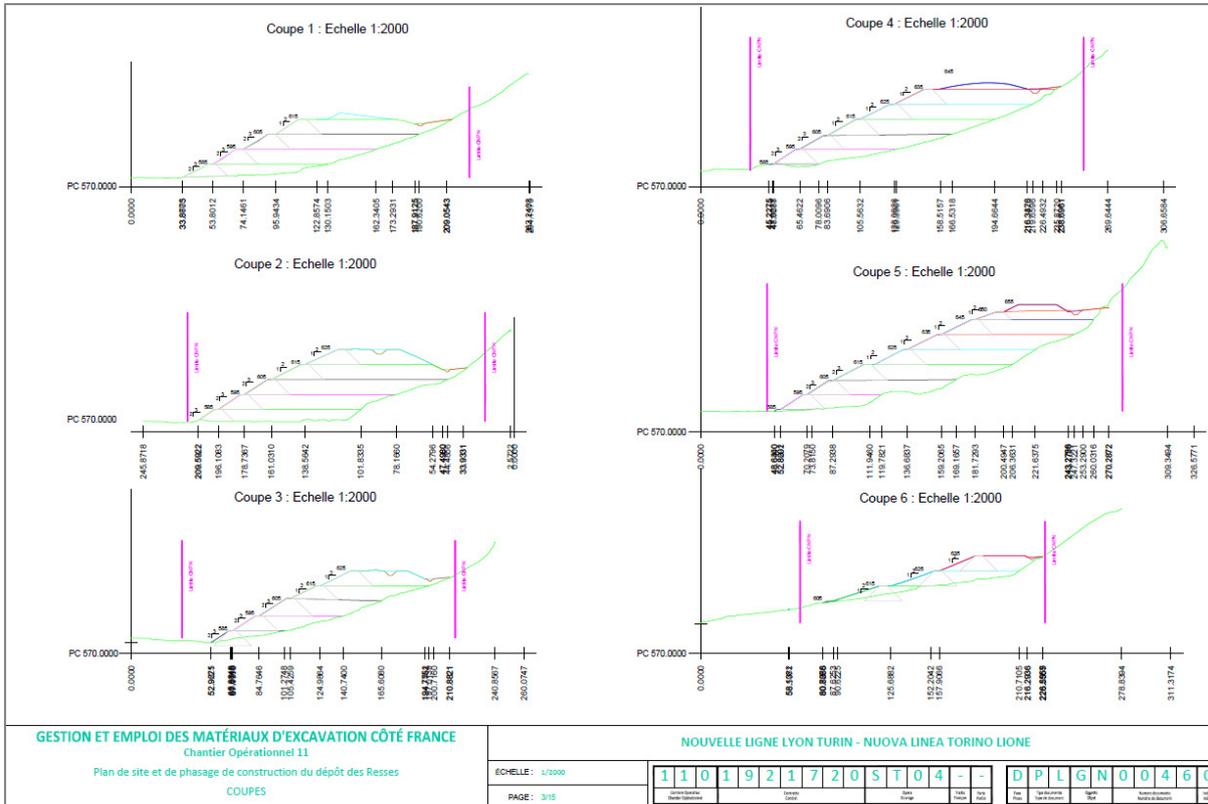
Vues en coupe du site de dépôt des Resses (ALTI, avril 2021)
